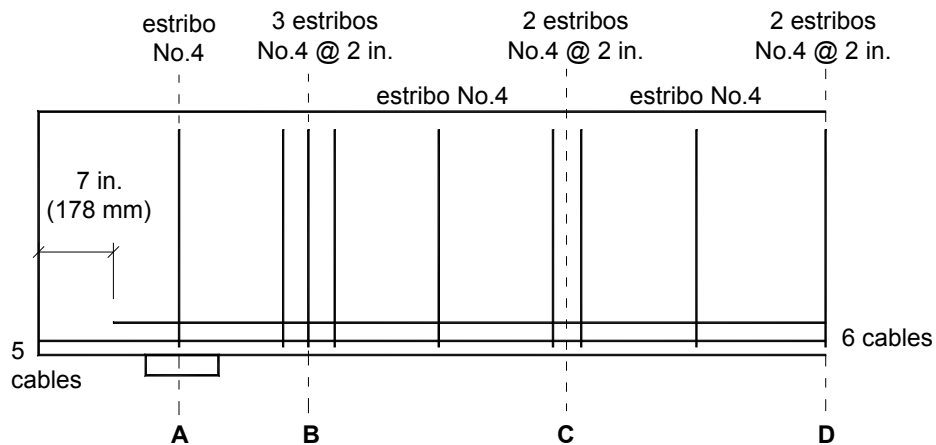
Configuración de las armaduras para la región del extremo de la viga
